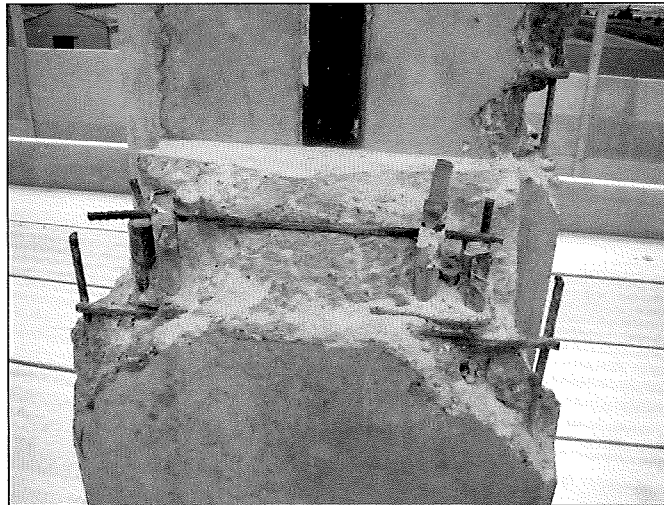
Configuración de armado en la cabeza de un pilar prefabricado
